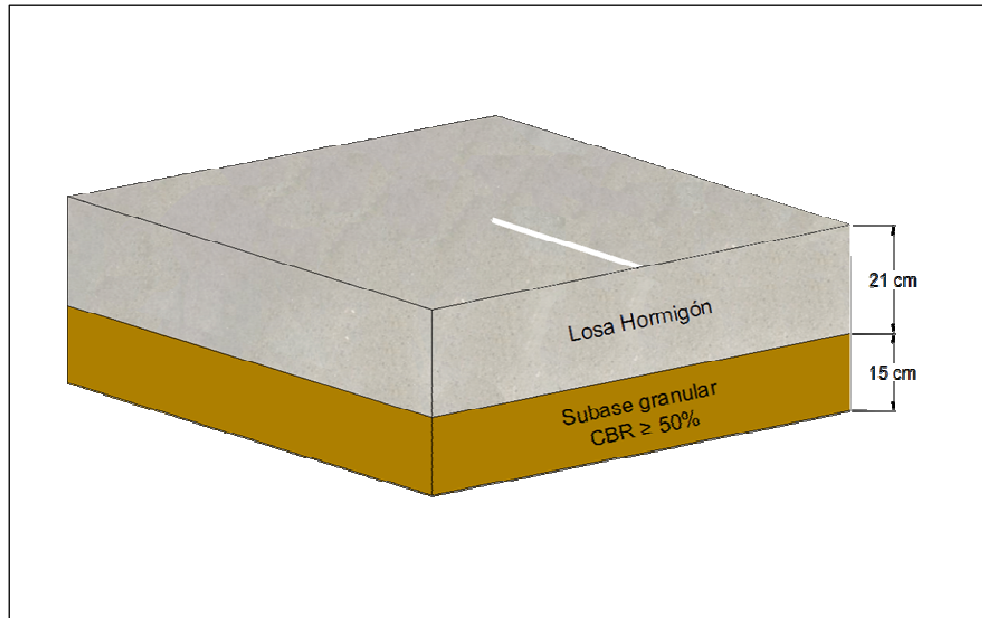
Esquema de la estructura de pavimento de hormigón construida para losas con sistema de traspaso de carga según método AASHTO.
